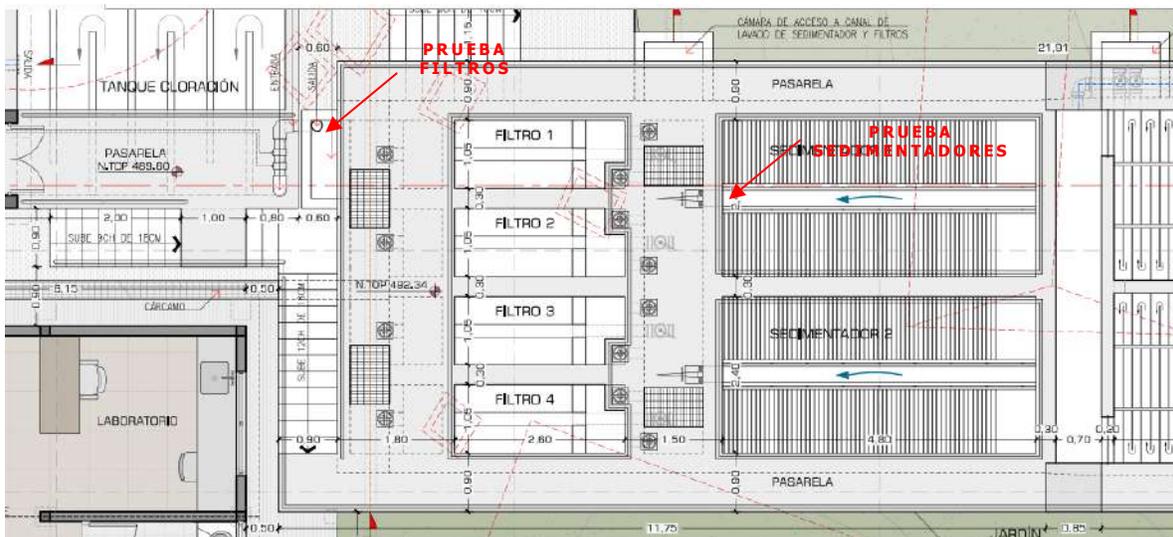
Vista en Planta de los tanques de sedimentación y filtros
